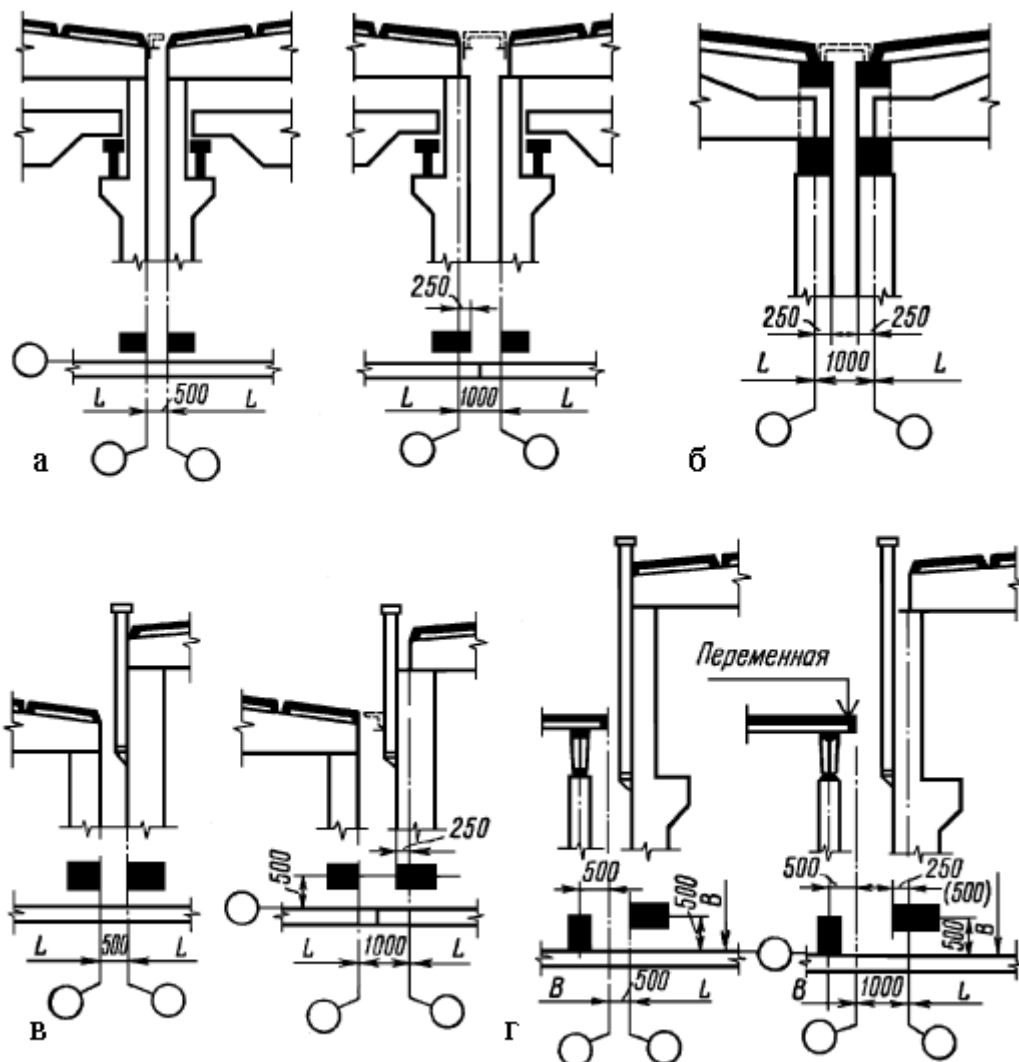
Привязка колонн в местах температурных швов и перепадов высот пролетов: а - в зданиях с покрытием без подстропильных конструкций; б - то же, по подстропильным конструкциям; в - при перепаде высот пролетов одного направления; г - то же, пролетов взаимно перпендикулярного направления
